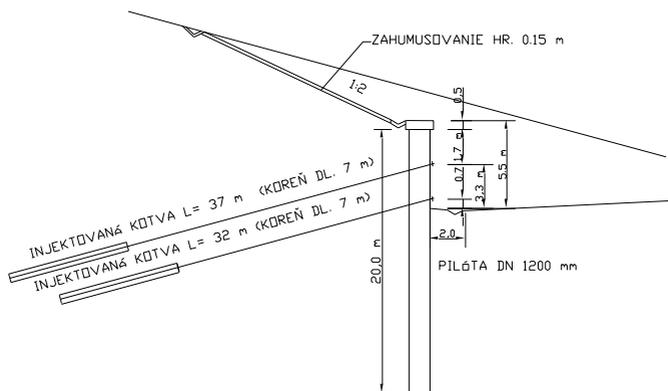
Заанкеренная в 2-х ярусах свайная стена длиной 20 м из свай \varnothing 1,2 м
